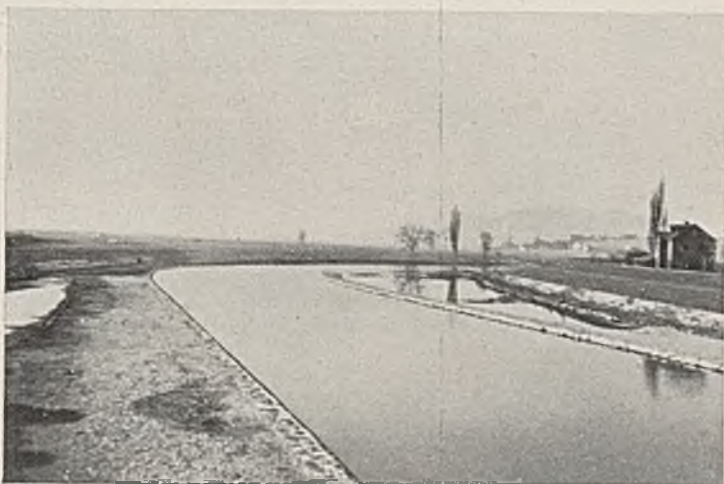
Blick von der Mainbrücke in Lichtenfels nach Einbau eines NW-Gerlnnes.
